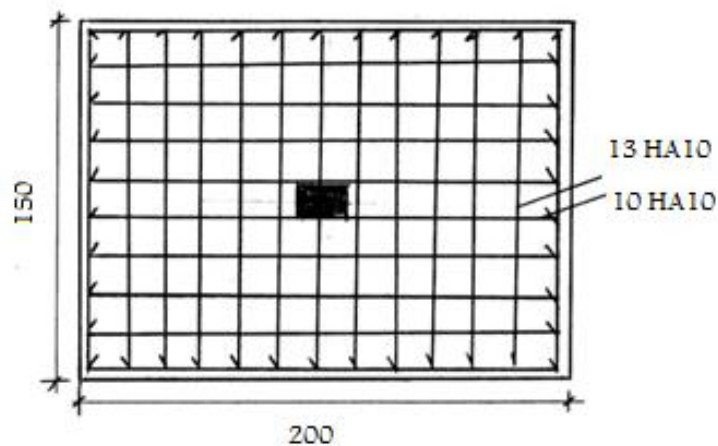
Vue en plan du schéma de ferrailage de la semelle selon les calculs du DTU 13.12
